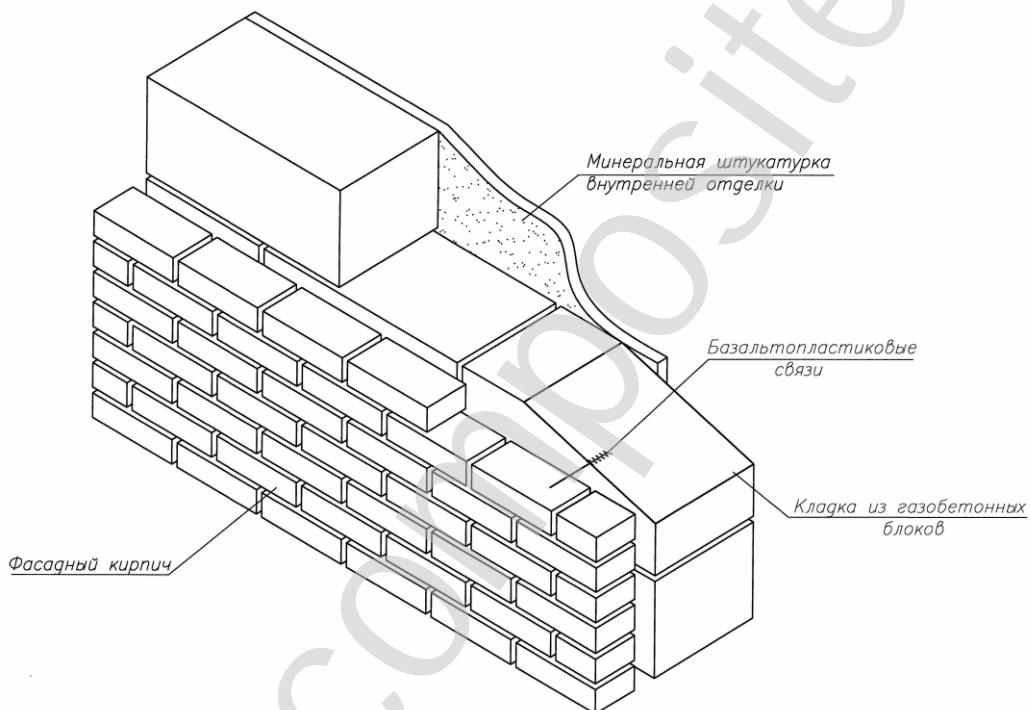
Конструкция стены с несущим слоем из газобетонных блоков и облицовочным кирпичом
